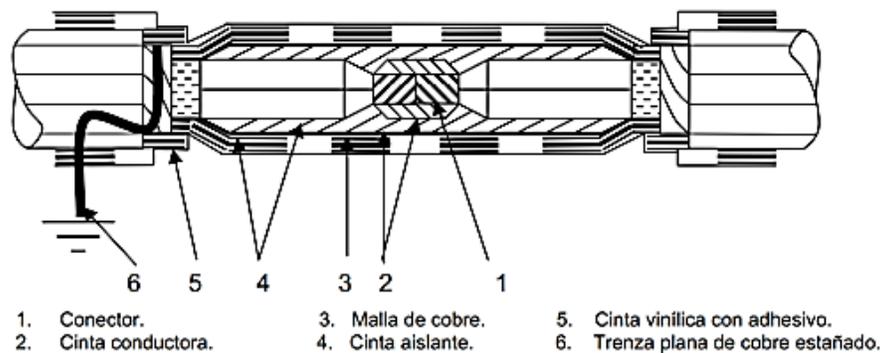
27. Detalles constructivos de empalmes encintados en cable monofásico con aislamiento extruido [34].
